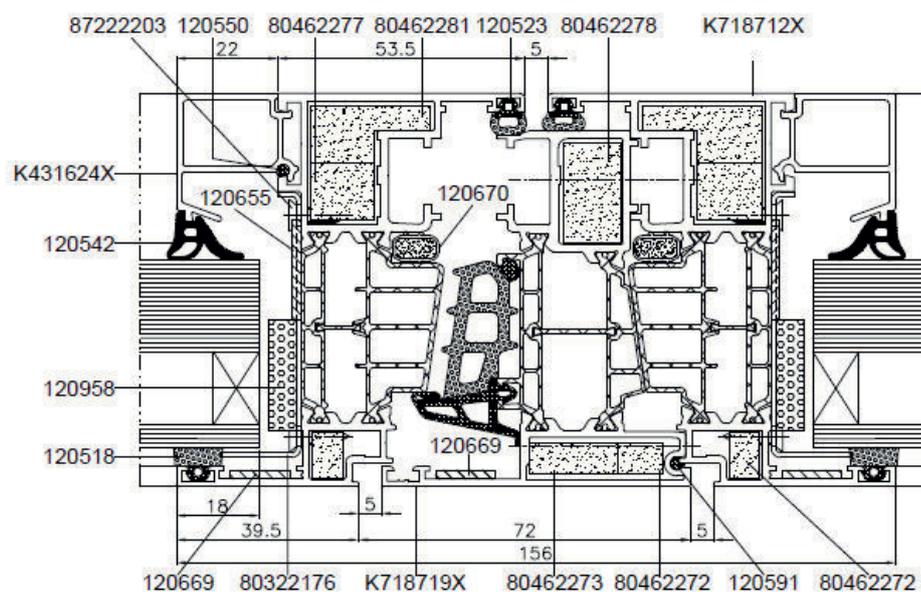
Beispiele für Querschnitte durch einen beweglichen Pfosten eines zweiflügeligen Fensters
